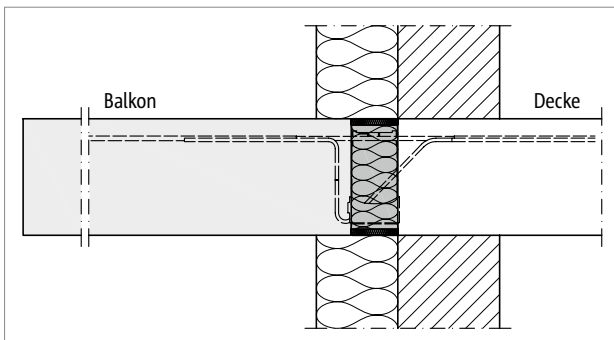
Schöck Isokorb® T Typ ZL, KL: Wärmedämmverbundsystem (WDVS)
